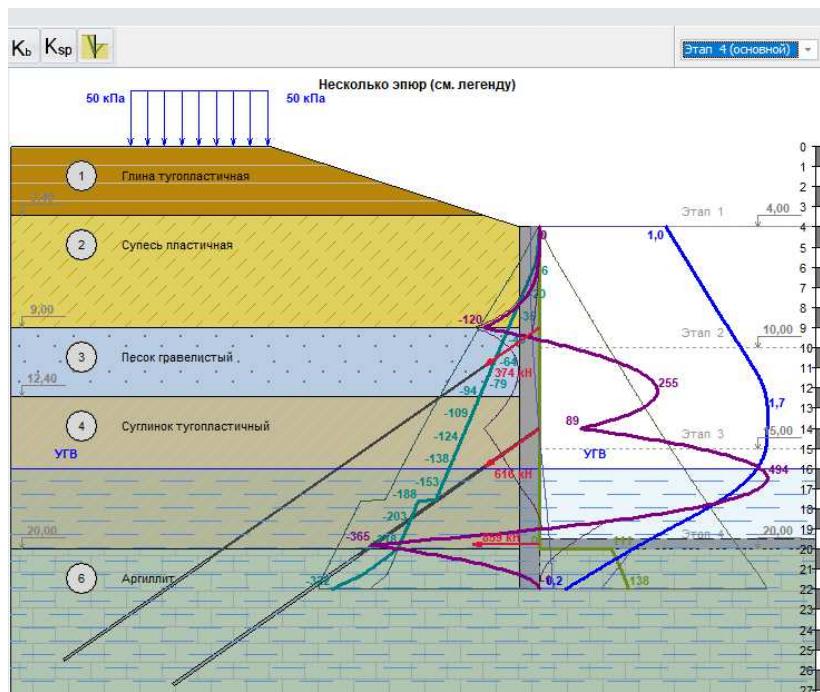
4 этап: разработка котлована до его дна и устройство фундаментной плиты
